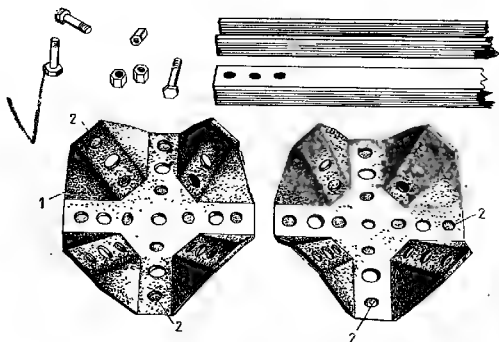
Узловое соединение со штампованными фасонками. Фрагмент плиты («Юнистрат», США)
